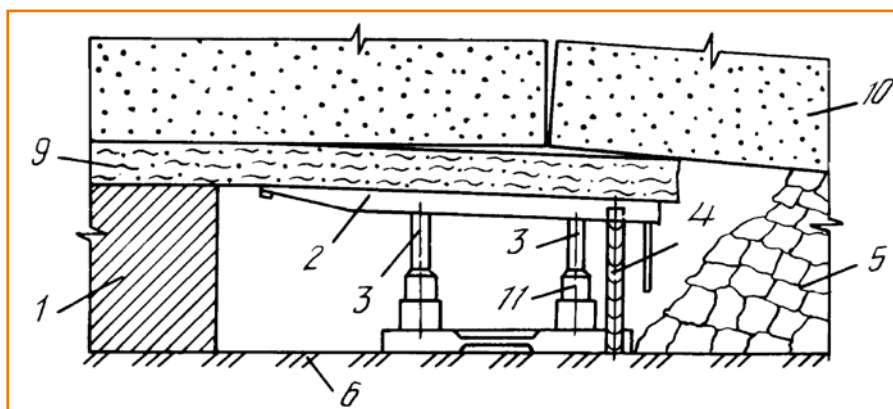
Схема разрушения слоистой кровли угольного пласта при его механизированной отработке
